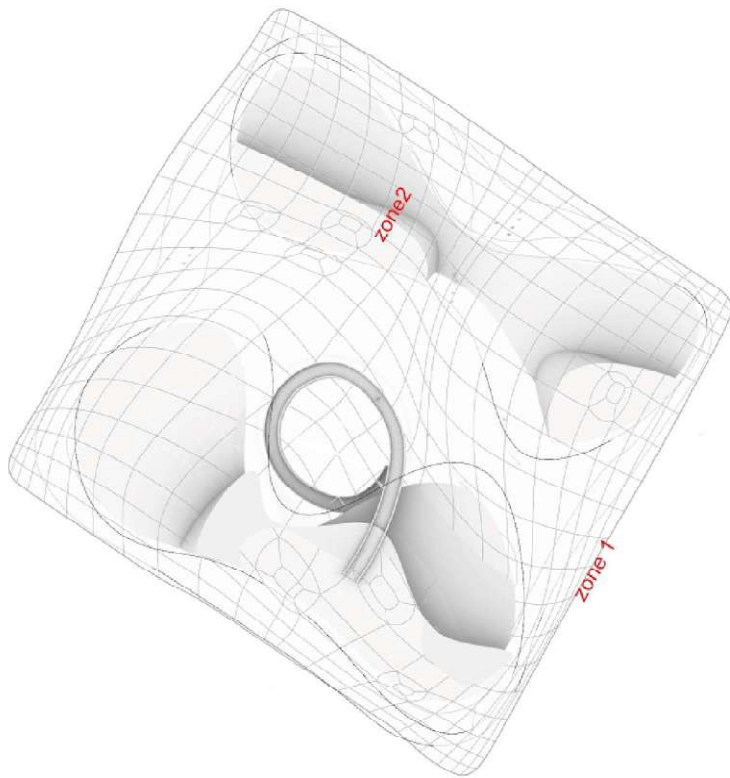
Formfindung, Erdgeschoss, Verbindungsrampe
